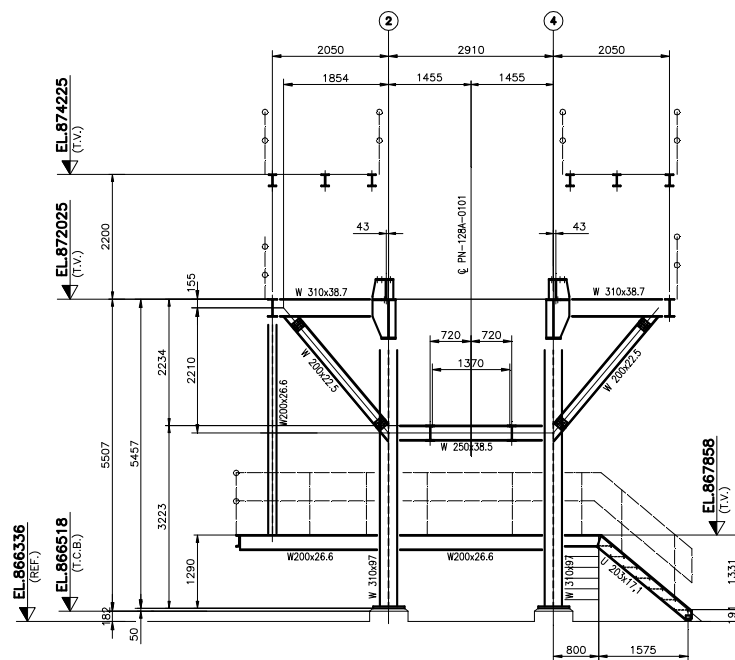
Desenho de Projeto – Elevação da Fila E.
